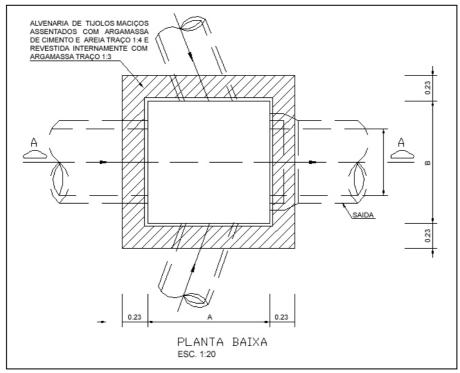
Poço de Visita com Chaminé Planta Baixa.
